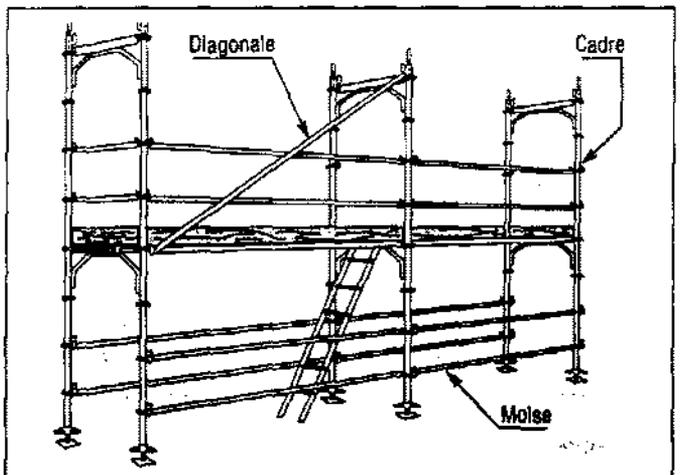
Vue générale d'un échafaudage à cadres préfabriqués.
